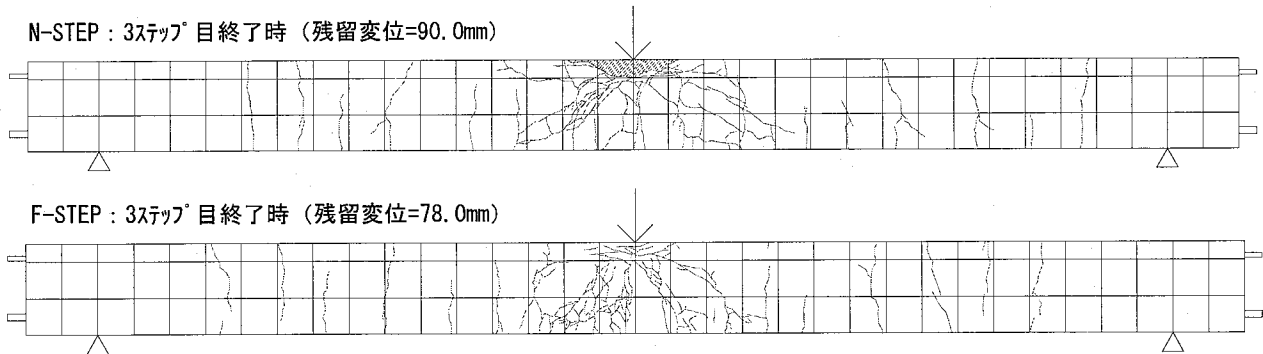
衝撃漸増載荷時のひび割れ発生状況 (3ステップ目終了時)
